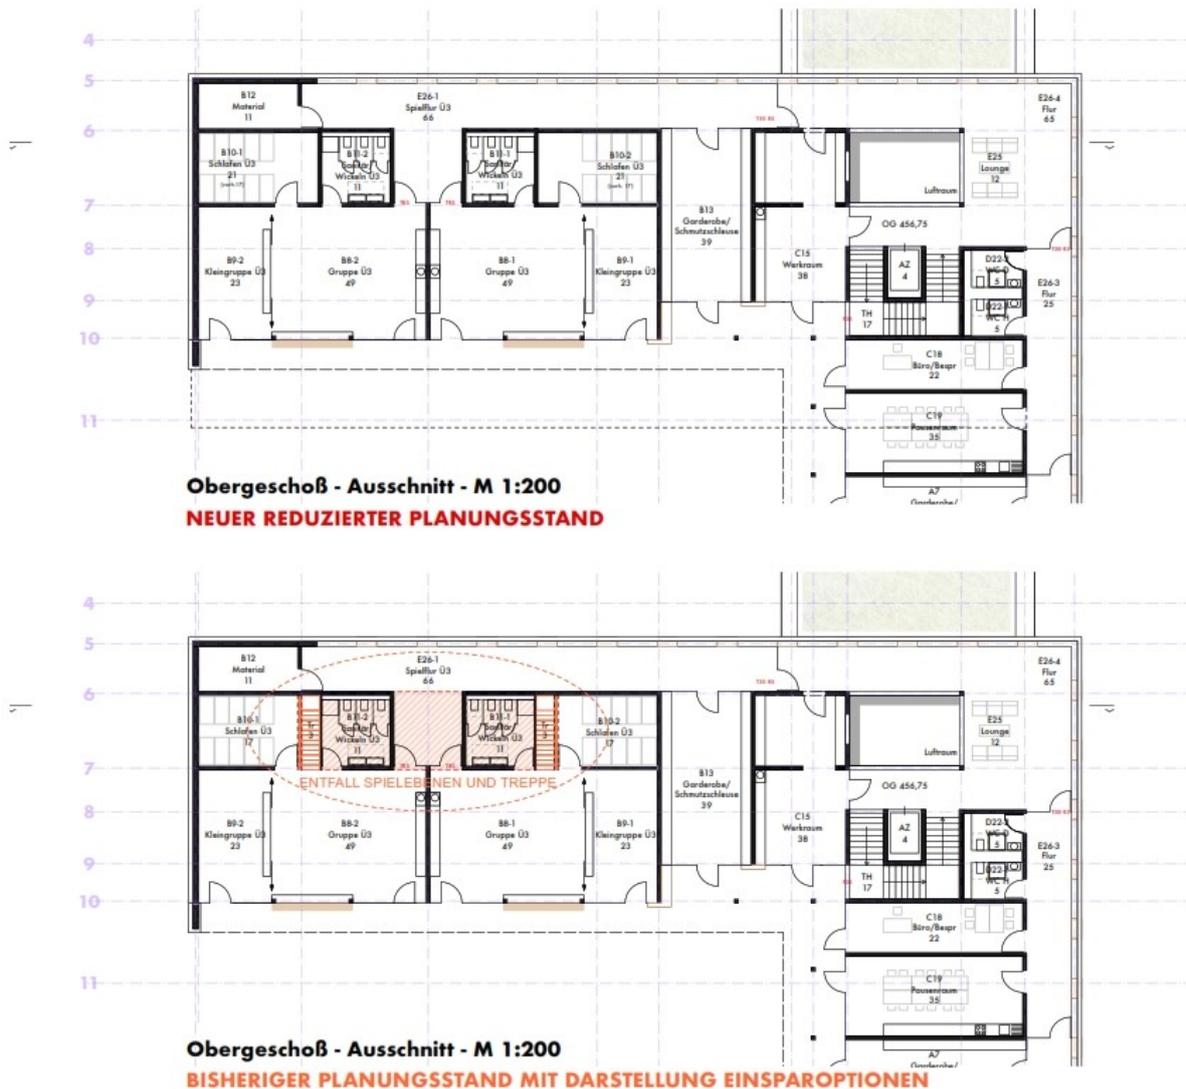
Darstellung Entfall Spielebene im Grundriss
